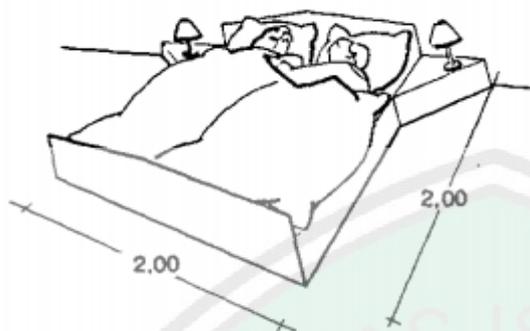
Standar denah apartemen (Ernst Neufert, 1996)
